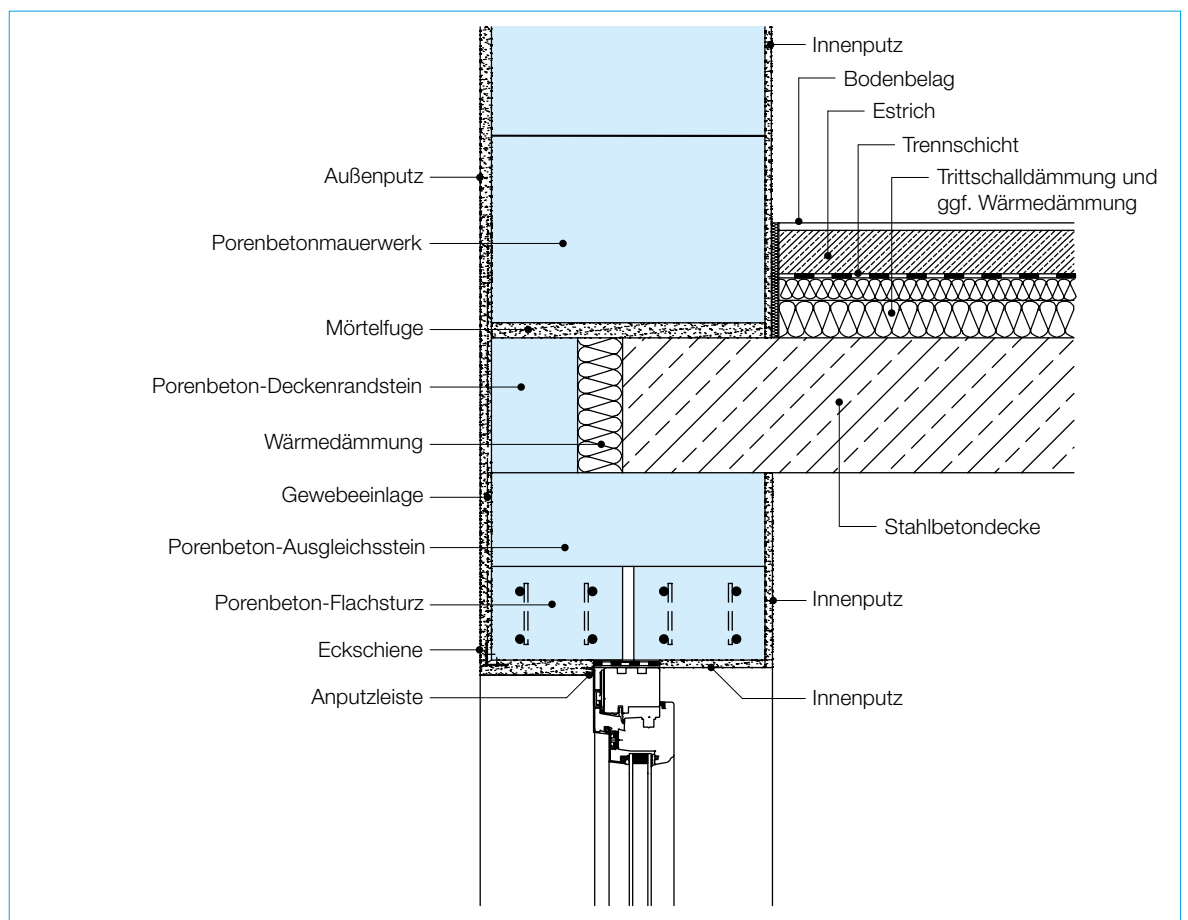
Einschalige Außenwand aus Porenbetonmauerwerk mit Anschluss an Stahlbetondecke und Fensteranschluss mit Porenbeton-Flachstürzen
